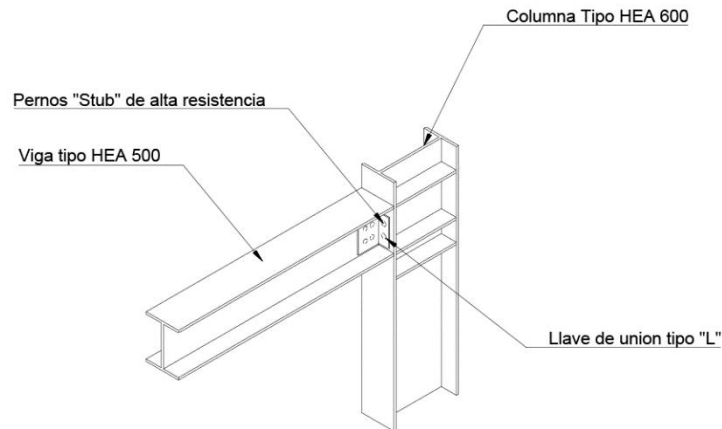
Detalle Union Viga-Columna Metálicas
